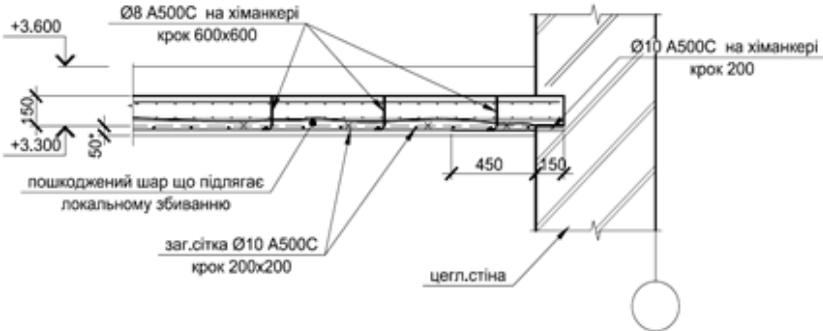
Пристінний розріз армування підсиленої плити перекриття
